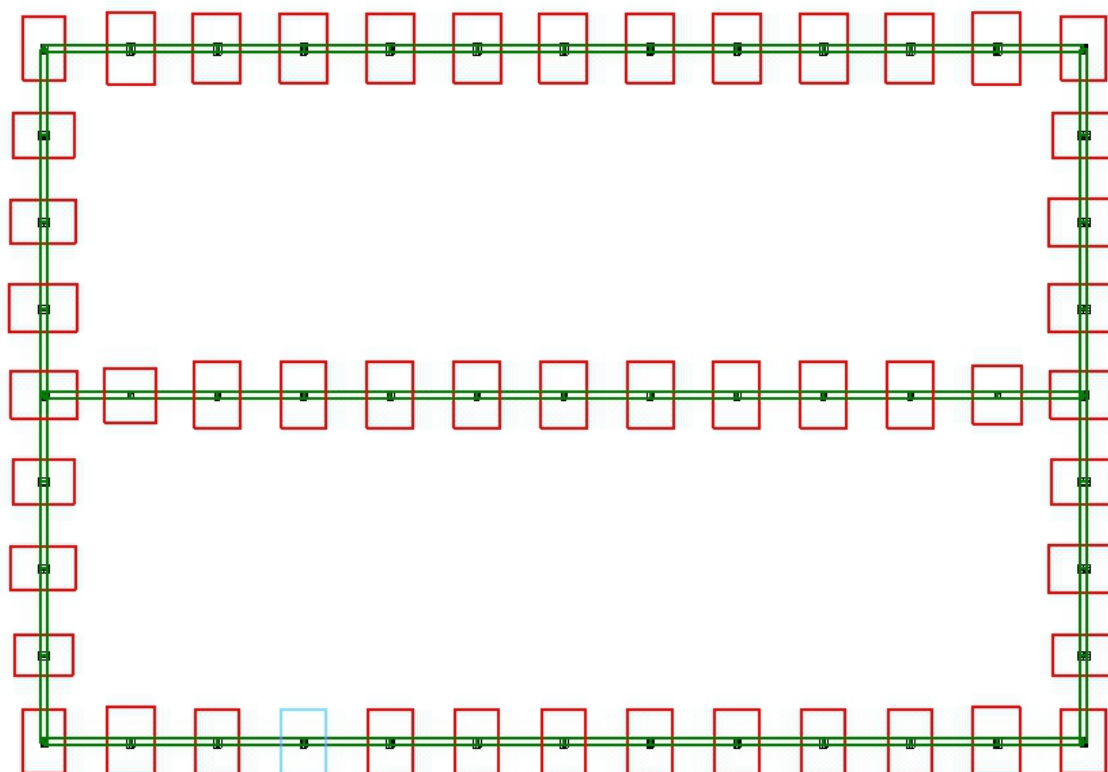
Zapatas y vigas de atado tras el dimensionado
